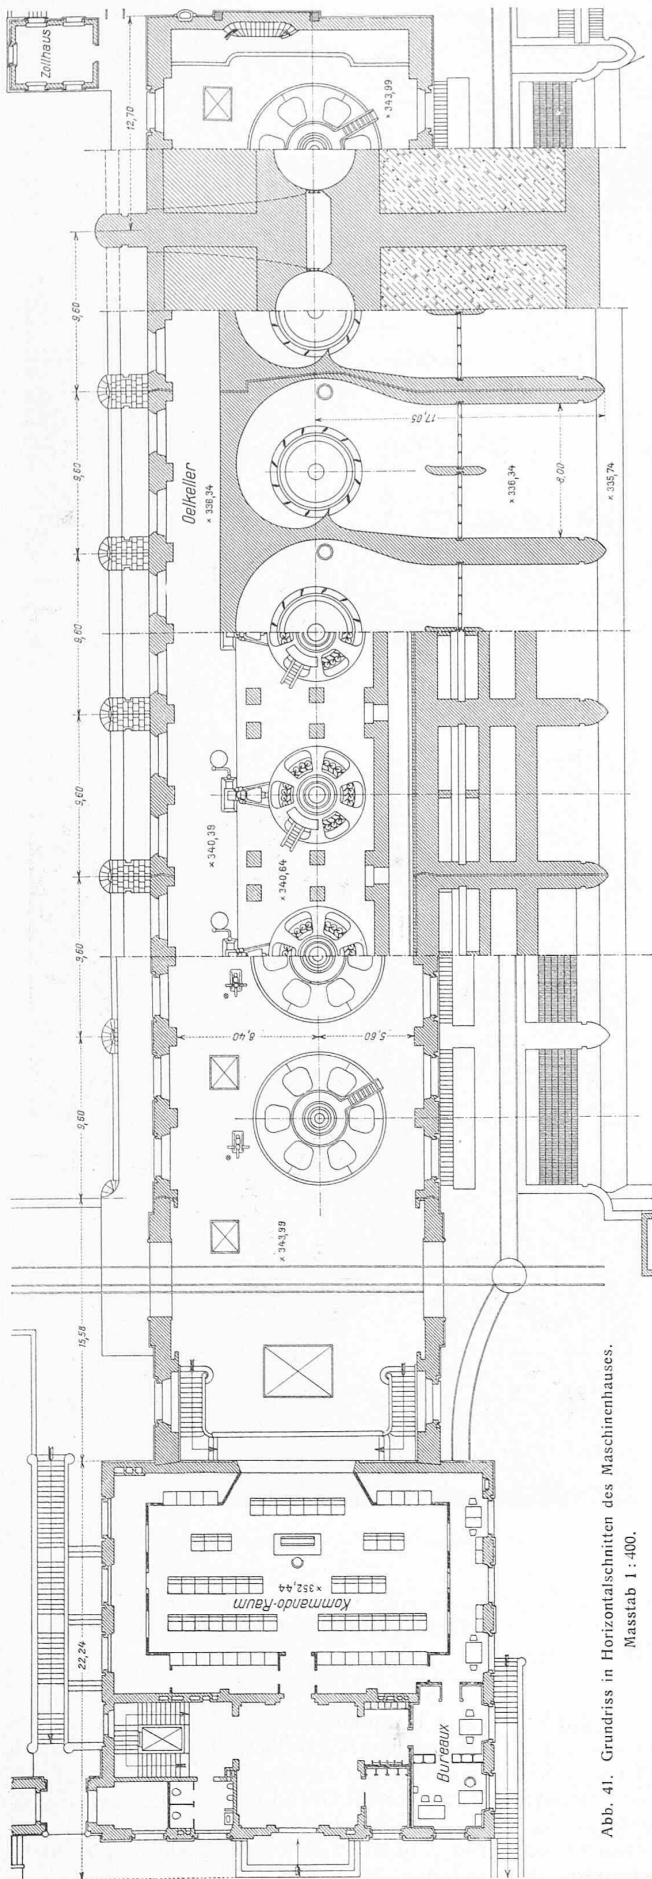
Grundriss in Horizontalschnitten des Maschinenhauses.
